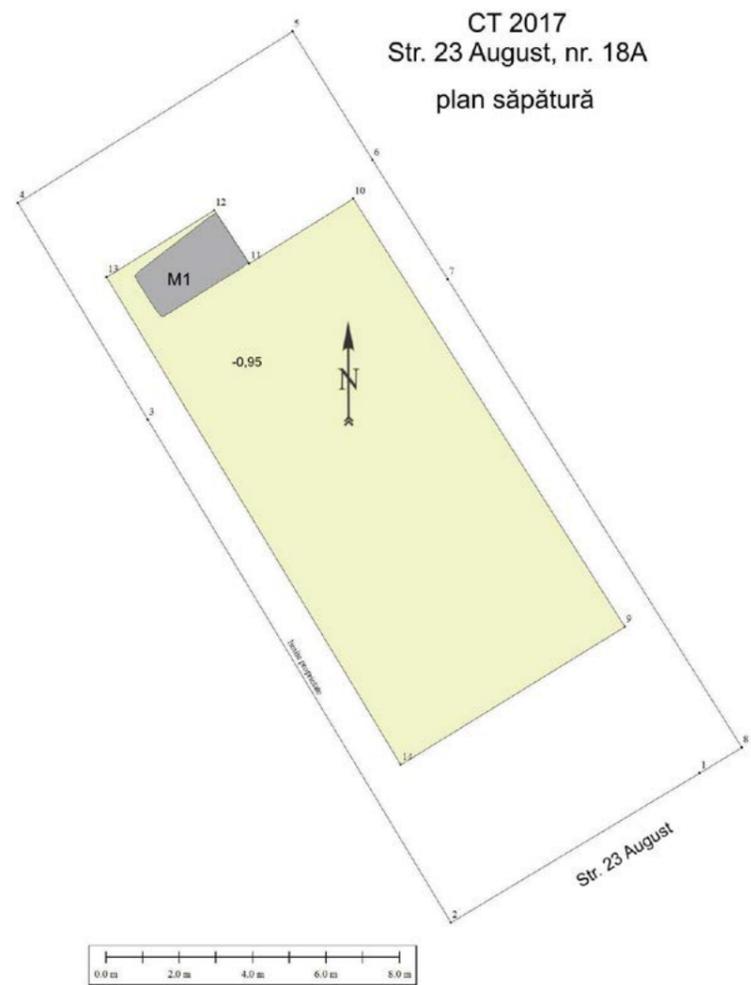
Constanța - str. 23 August, nr. 18A, plan săpătură.
